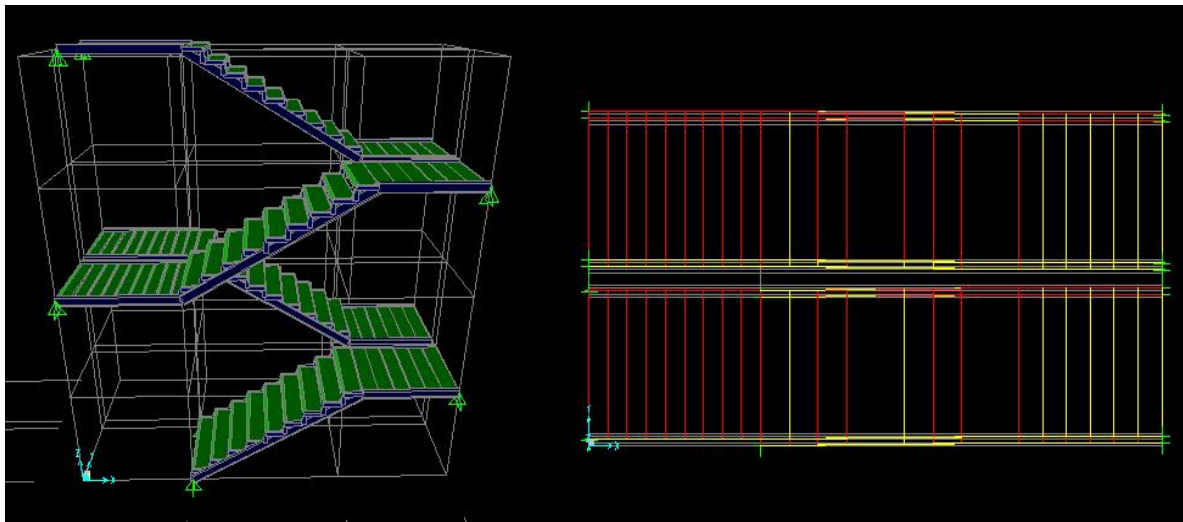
Modélisation 3d et projection en plan de l'escalier.
